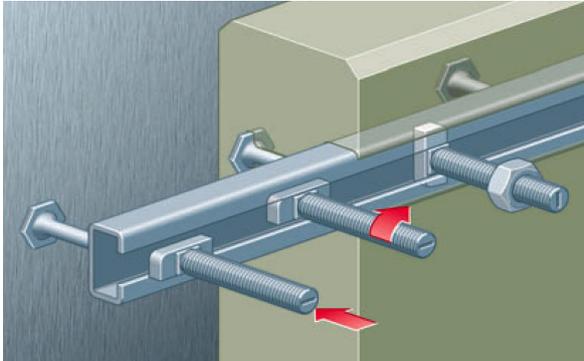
Prinzipdarstellung: einbetonierte Halfen-Schienen mit entsprechenden Befestigungsschrauben. [55]
